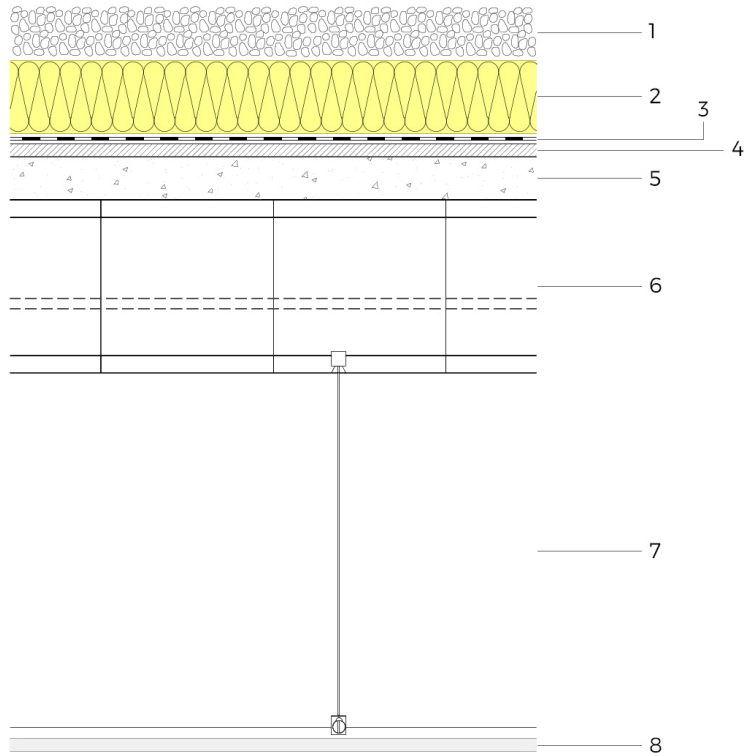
Detalle constructivo de cubierta del modelo A tras rehabilitación.
